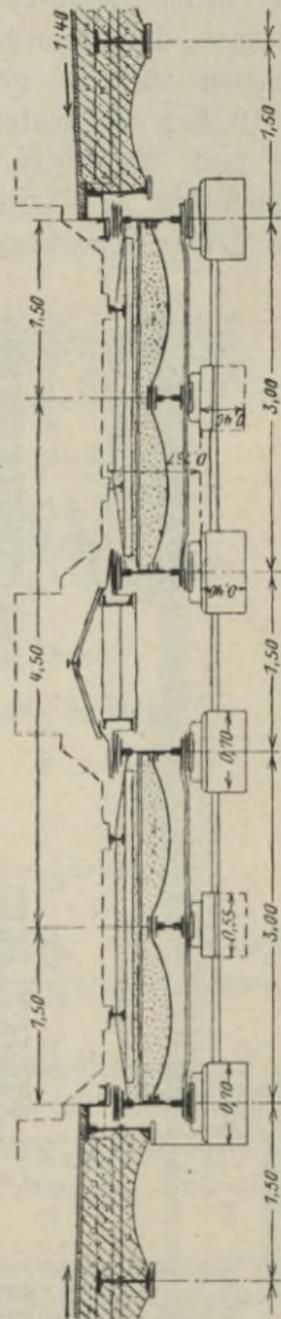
Längsschnitt durch die Decke eines 6 m weiten Tunnels nach Breslauer Muster. M. rd. 1 : 92.
